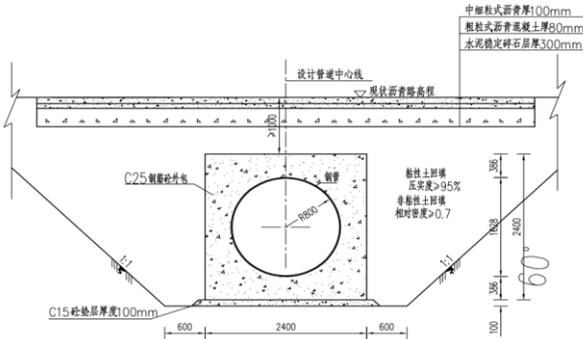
穿路埋管段设计典型一横断面图 (单位: mm)
